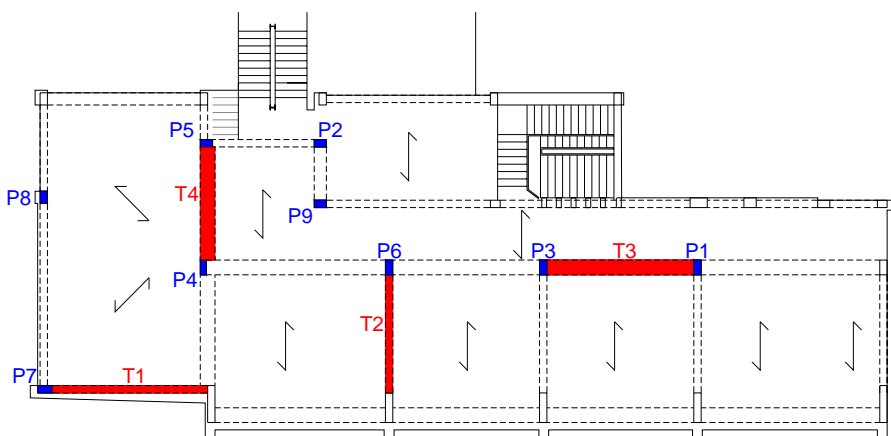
Schema strutturale della parte di scuola in esame e collocazione planimetrica dei campioni estratti (travi in rosso, pilastri in blu).
